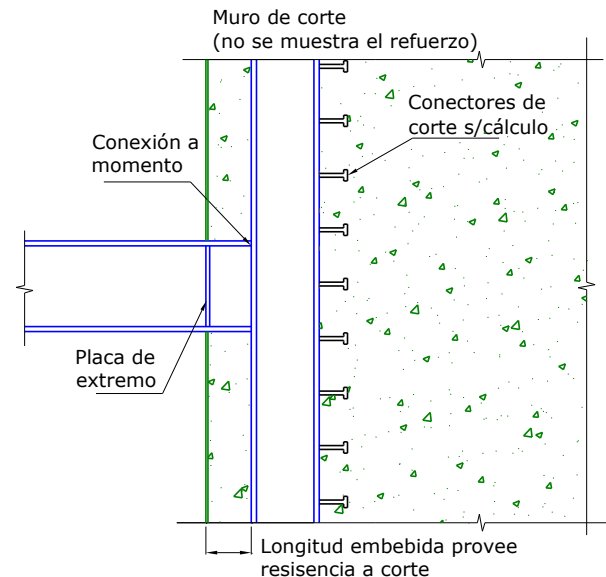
Viga de acople de acero conectada a un elemento de acero de borde con conexión de momento.
